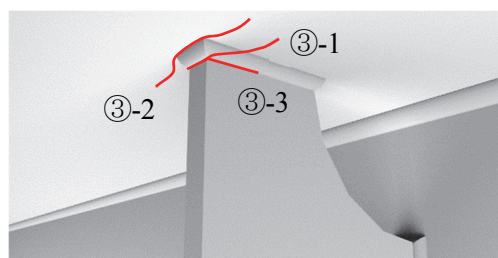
デッキプレート-垂直補剛材 溶接部の損傷タイプ(③)
